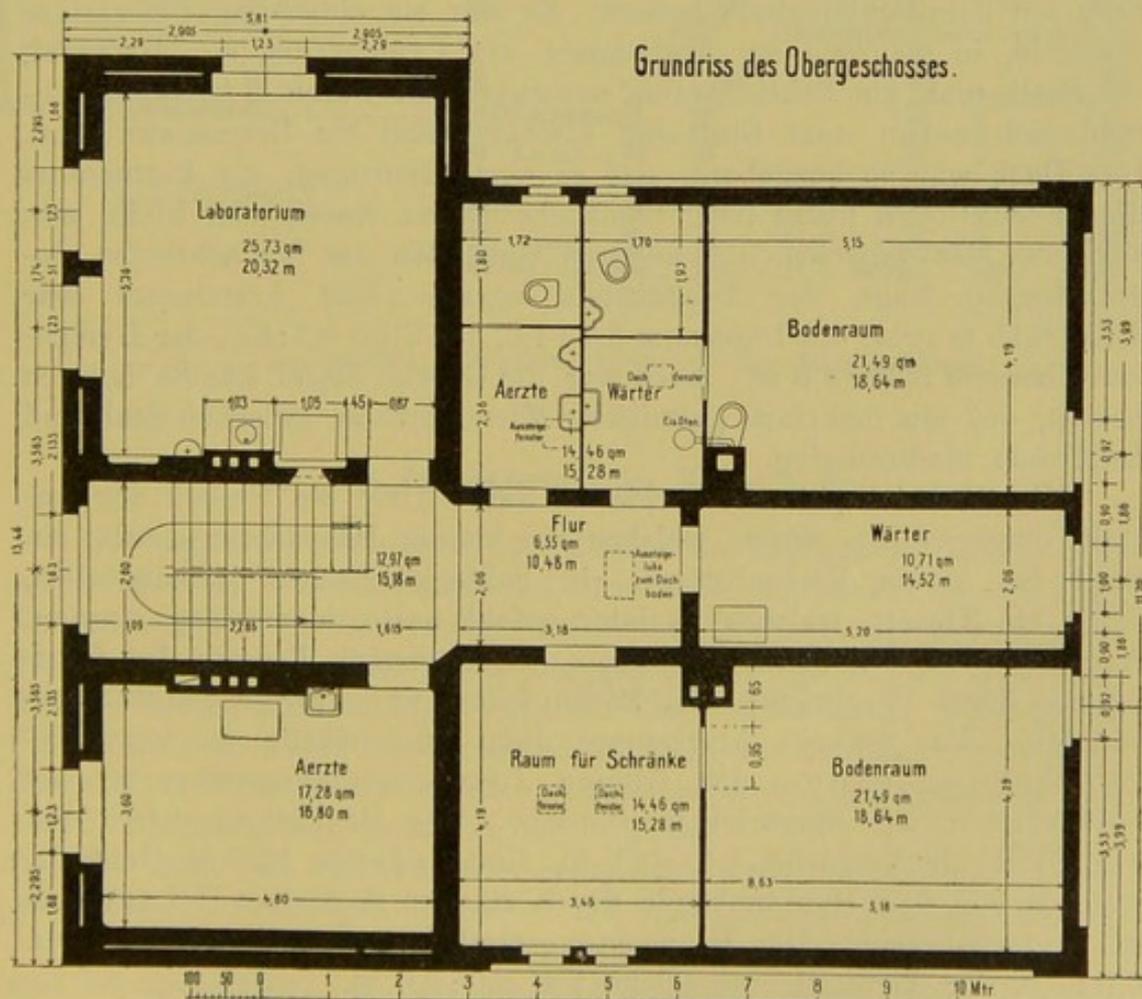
Impfanstalt in Stettin: Grundriß des Obergeschosses.
